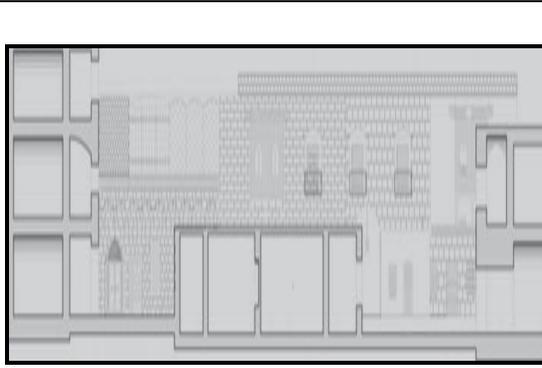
مسقط الطابق الأول لخان الغلبية بحلب وفق غاوييه عام 1984م (غاوييه) [24]
